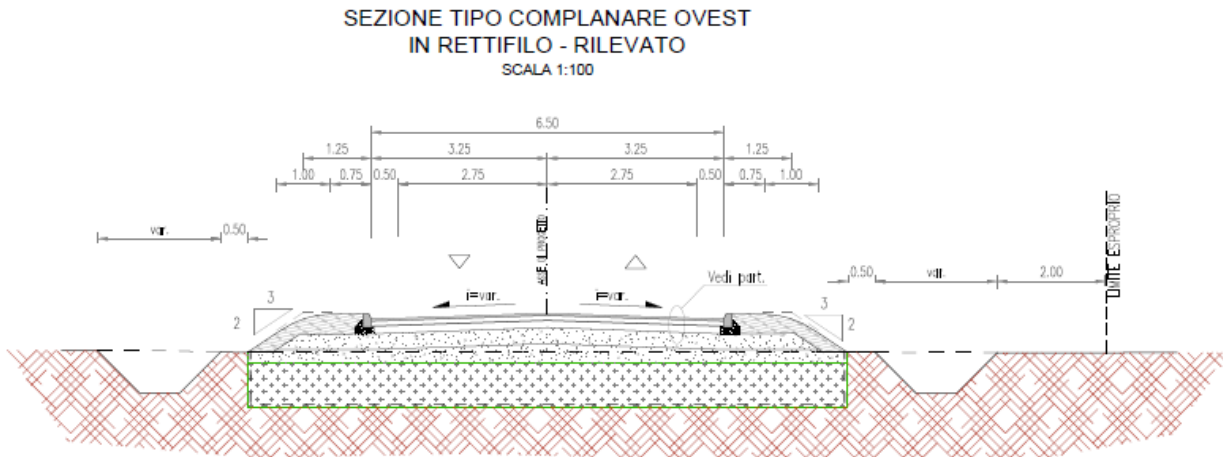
Sezione Tipo Complanare Ovest in rettilo
